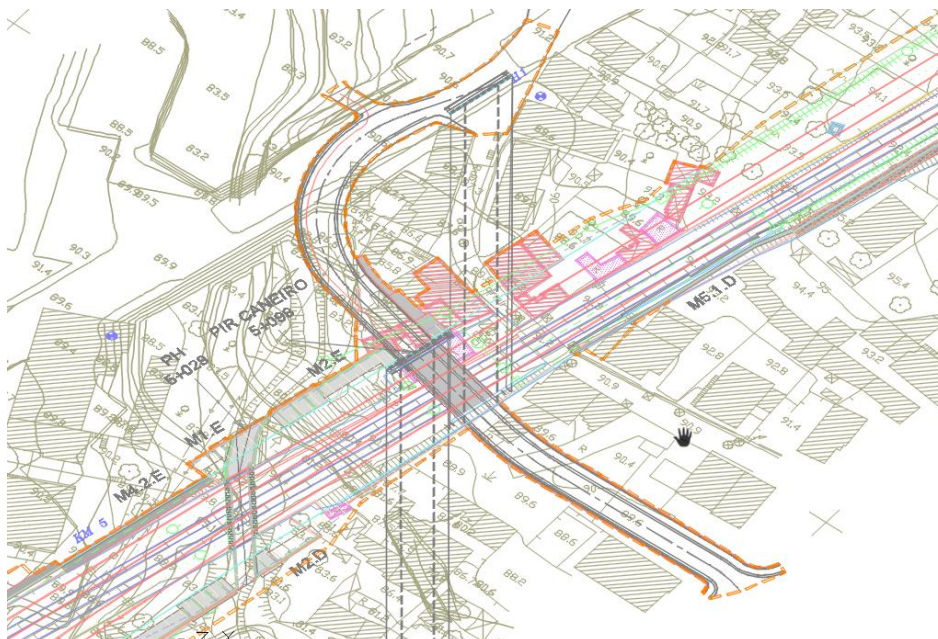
PIR da Rua do Caneiro (km 5+098)
